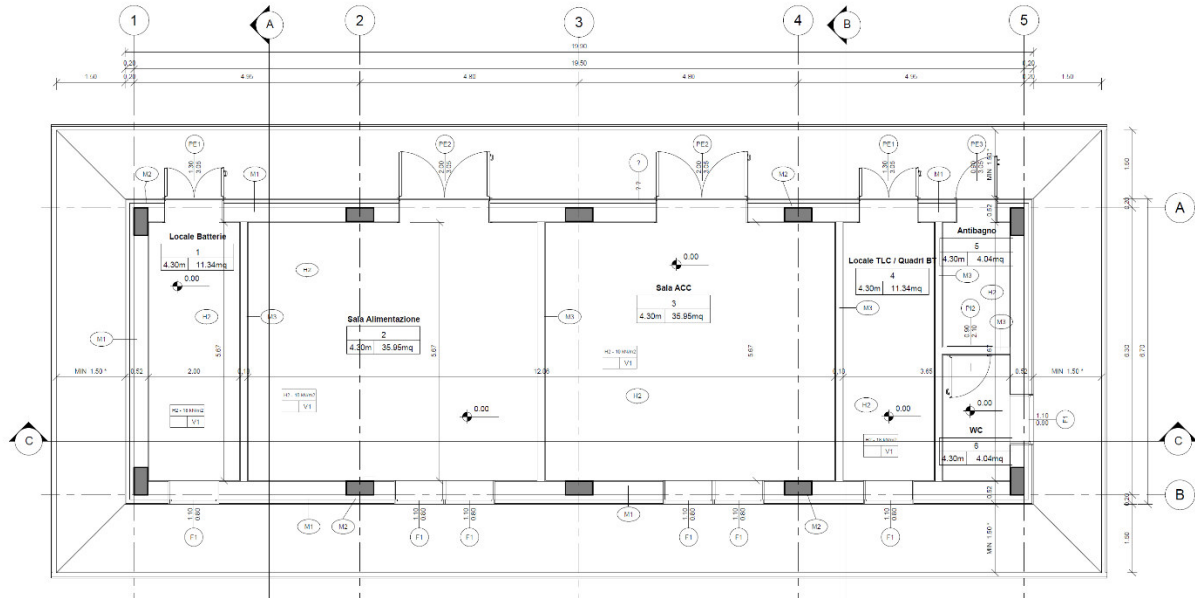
Pianta Architettonica Piano Terra – Layout Fabbricato FA01
